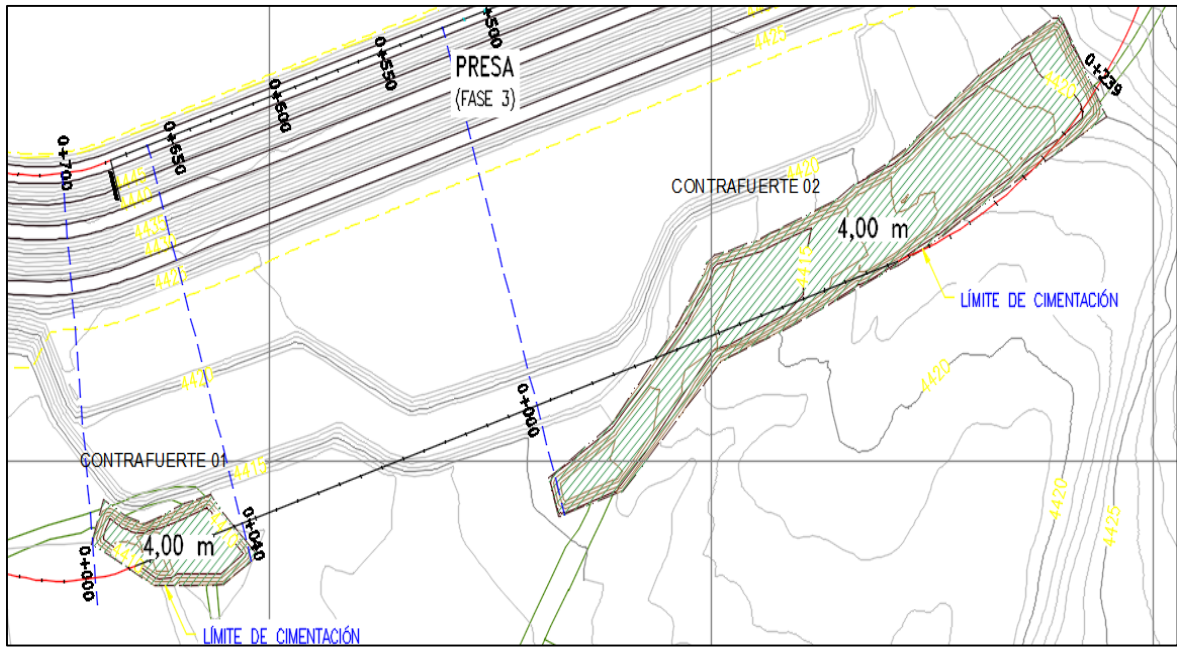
Plano de planta de Contrafuertes 01 y 02
